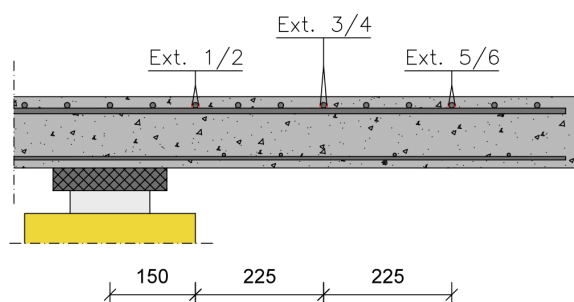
Disposição dos extensómetros na armadura longitudinal superior no modelo ND0 (desenho sem escala e dimensões em mm).
